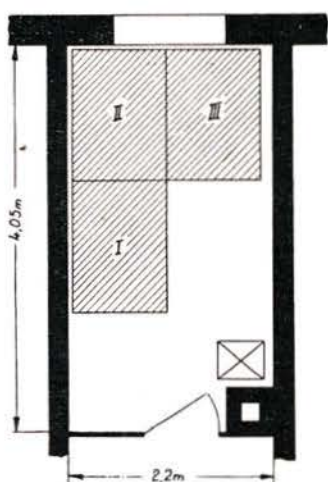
Grundriß eines halben Zimmers für eine Modellbahnanlage.
